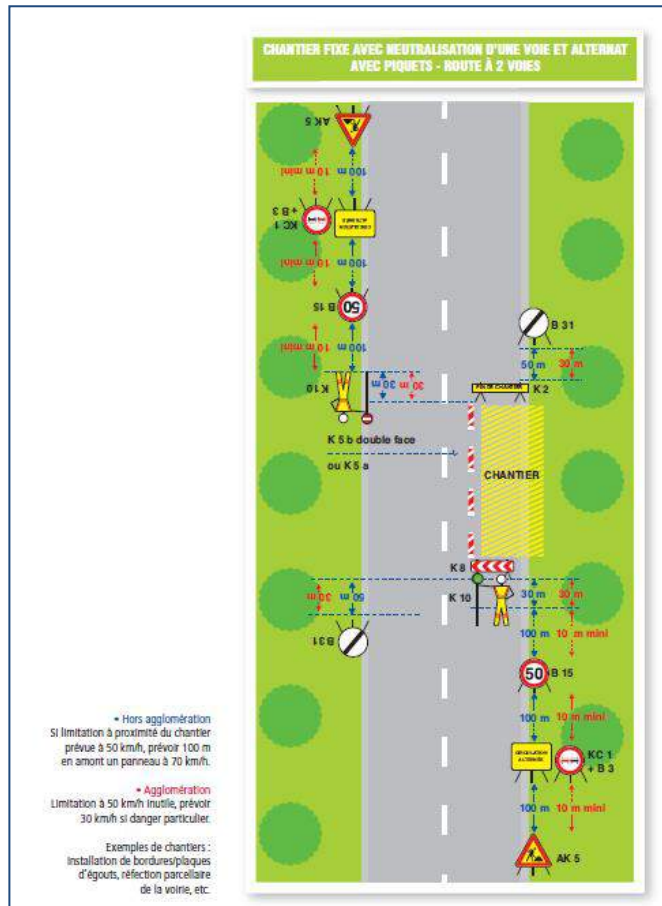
Exemple d'une signalisation temporaire d'un chantier fixe avec neutralisation d'une voie et alternat avec piquets
